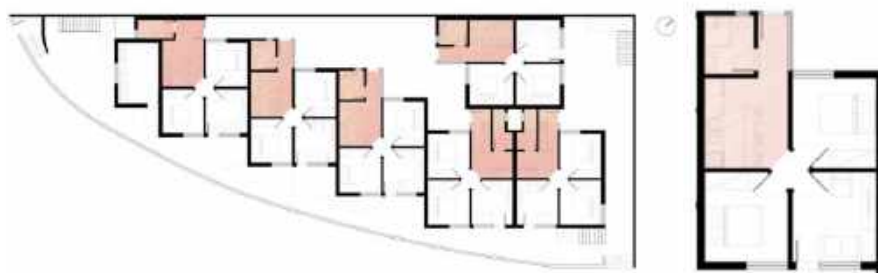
e 14b: Disposição das unidades. (a) térreo; (b) primeiro pavimento.
